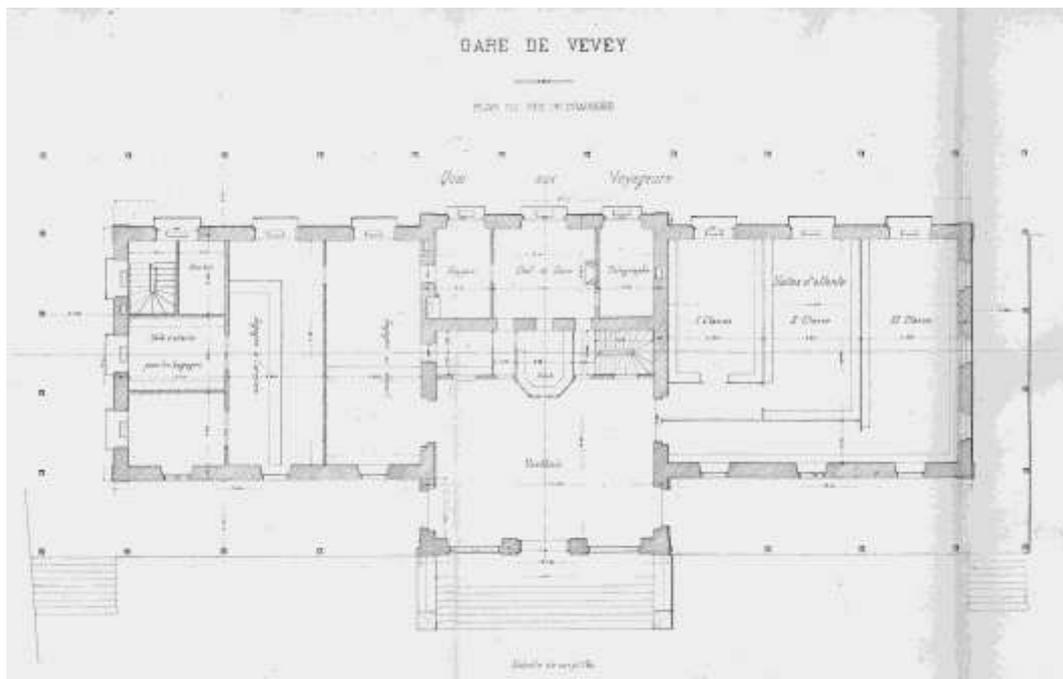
Première gare de Vevey, 1861, Jean Fernel architecte, plan du rez-de-chaussée (MEYER, 1874, cf. Bibliographie).
